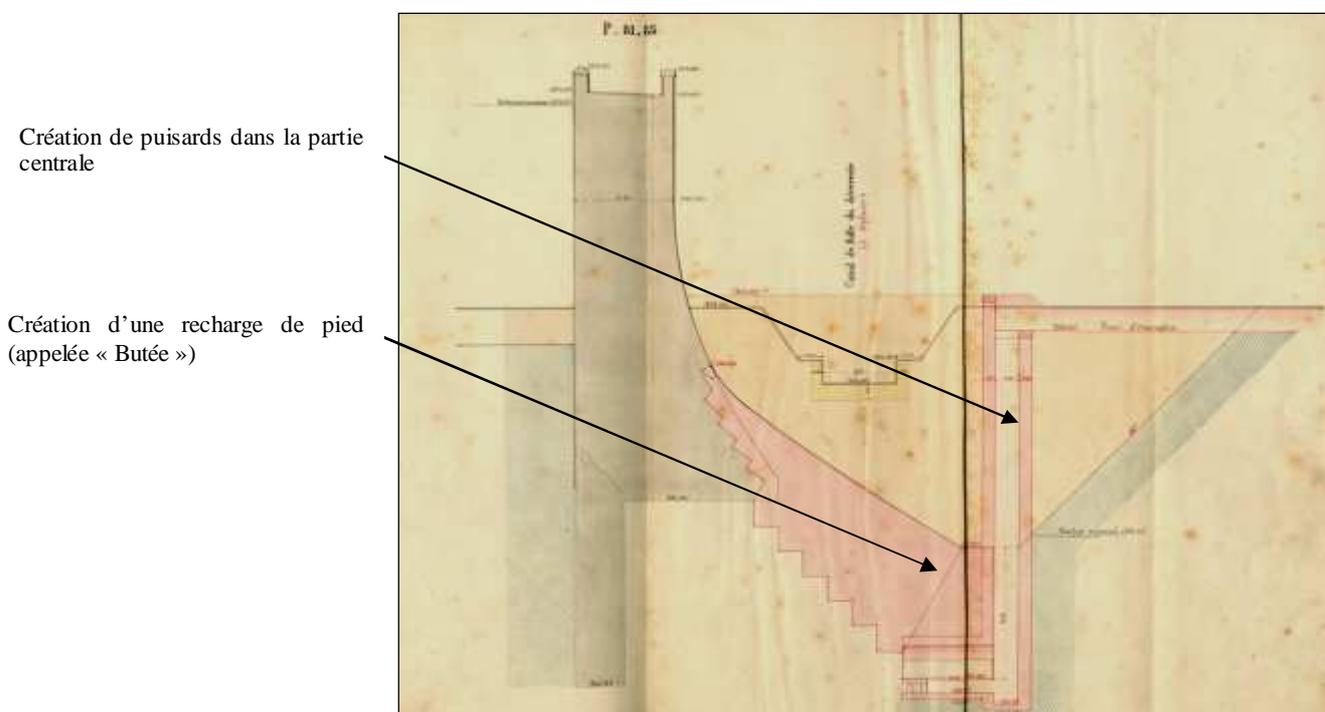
Coupe du projet de renforcement au niveau d'un puisard
